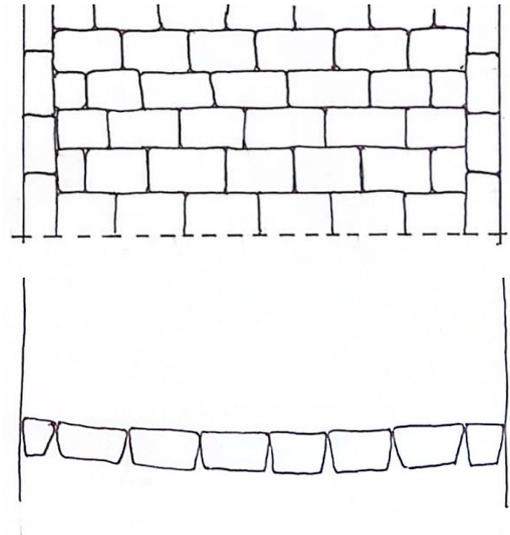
Boceto de planta y sección tipo de la pavimentación de rodano sin aceras en las calles de Valencia.
